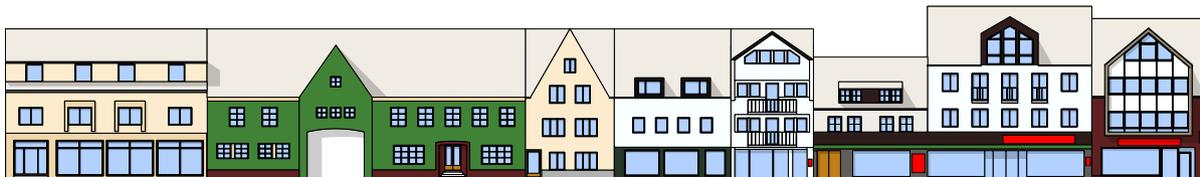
Hauptstraße 96 - 112: Die geschlossene Bebauung ist durch giebelständige Gebäude und Fassadenabschnitte gegliedert.
